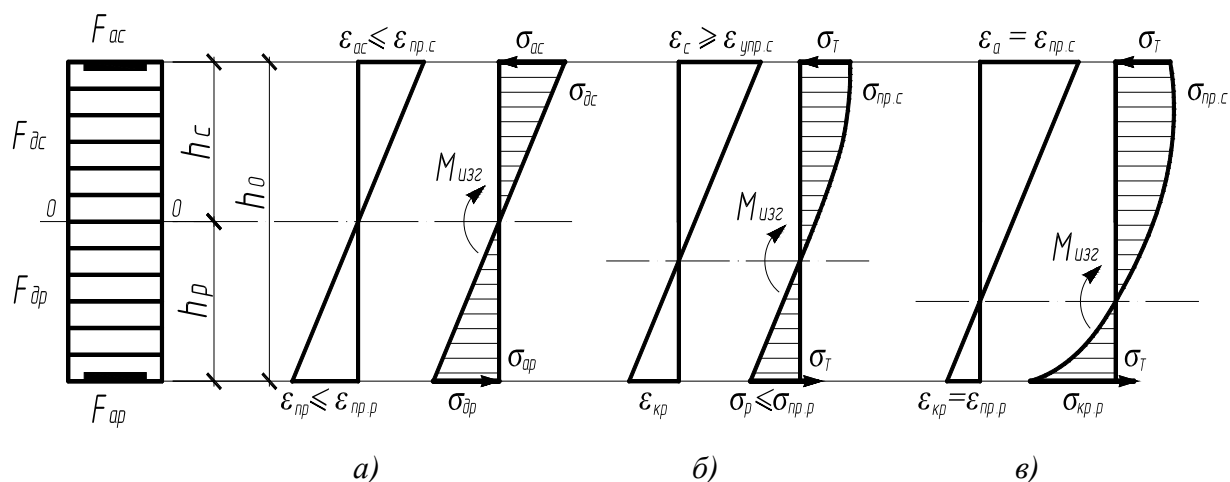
Стадия напряженно-деформированного состояния армированного деревянного элемента при изгибе : а – 1-я стадия (условно упругая); б – 2-я стадия (упругопластическая); в – 3-я стадия (разрушения)
